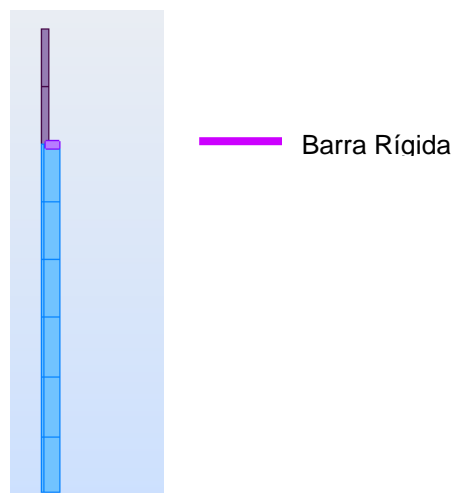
Pormenor da barra rígida no ROBOT.
